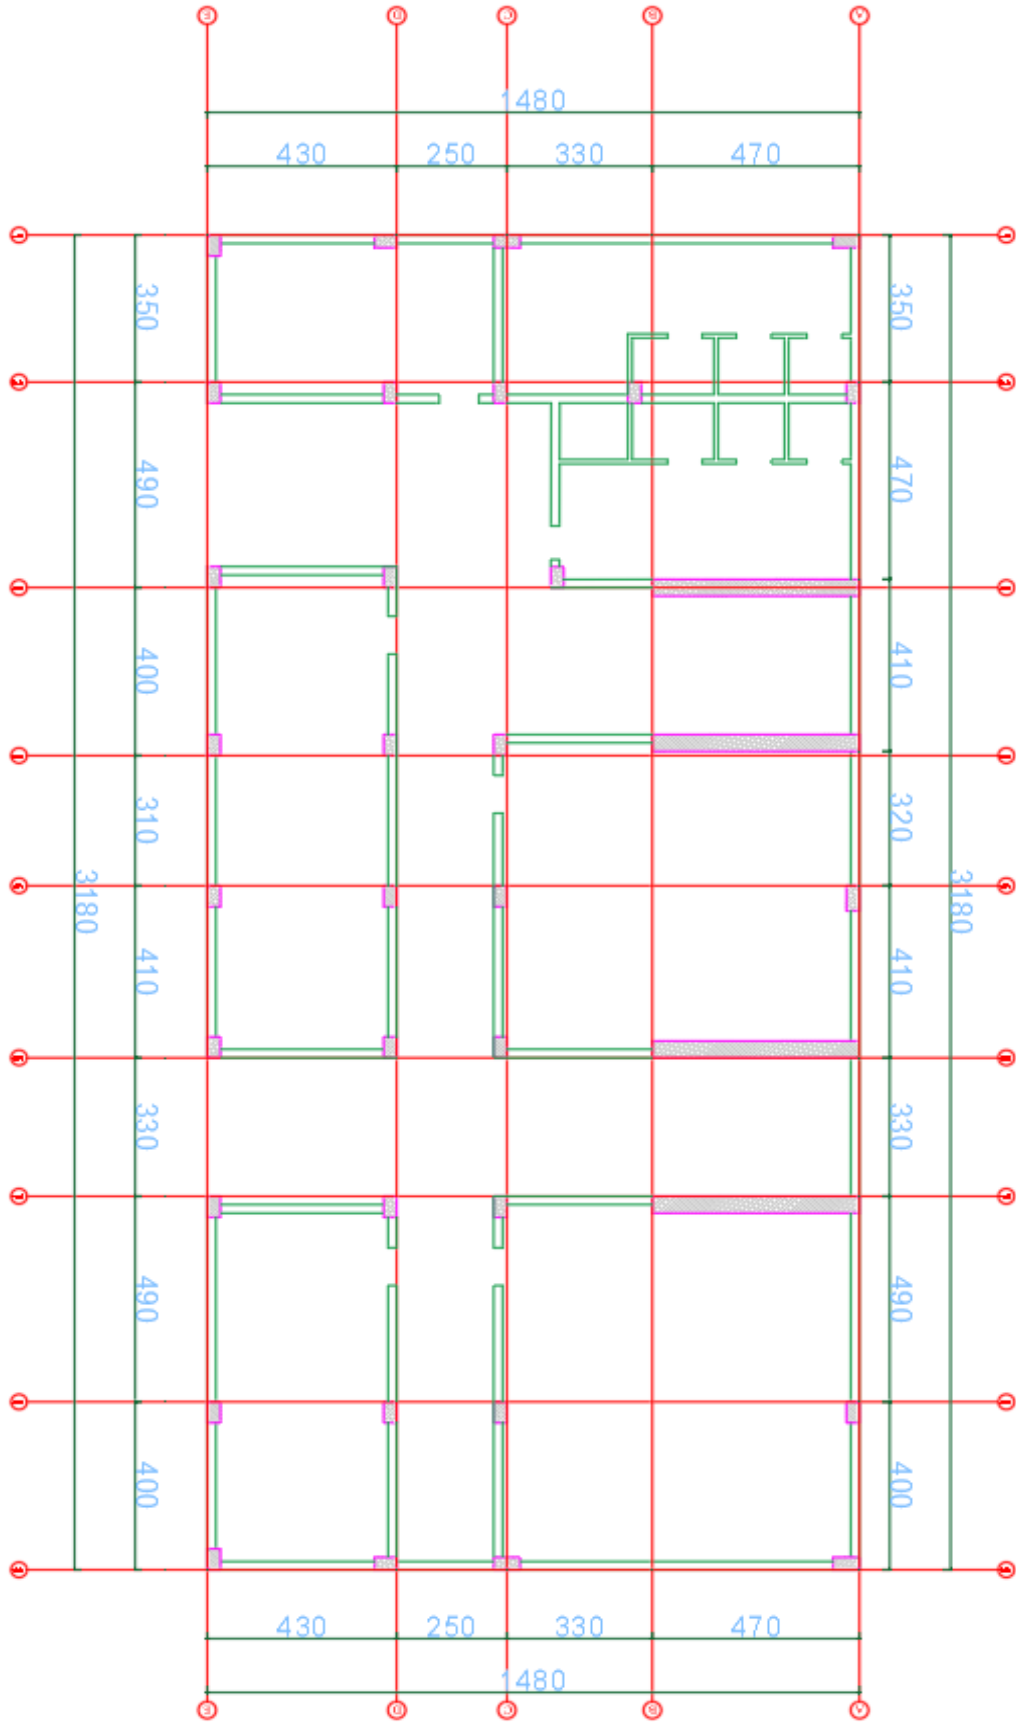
Bayburt Fen Lisesi zemin kat planı rölevesi.
